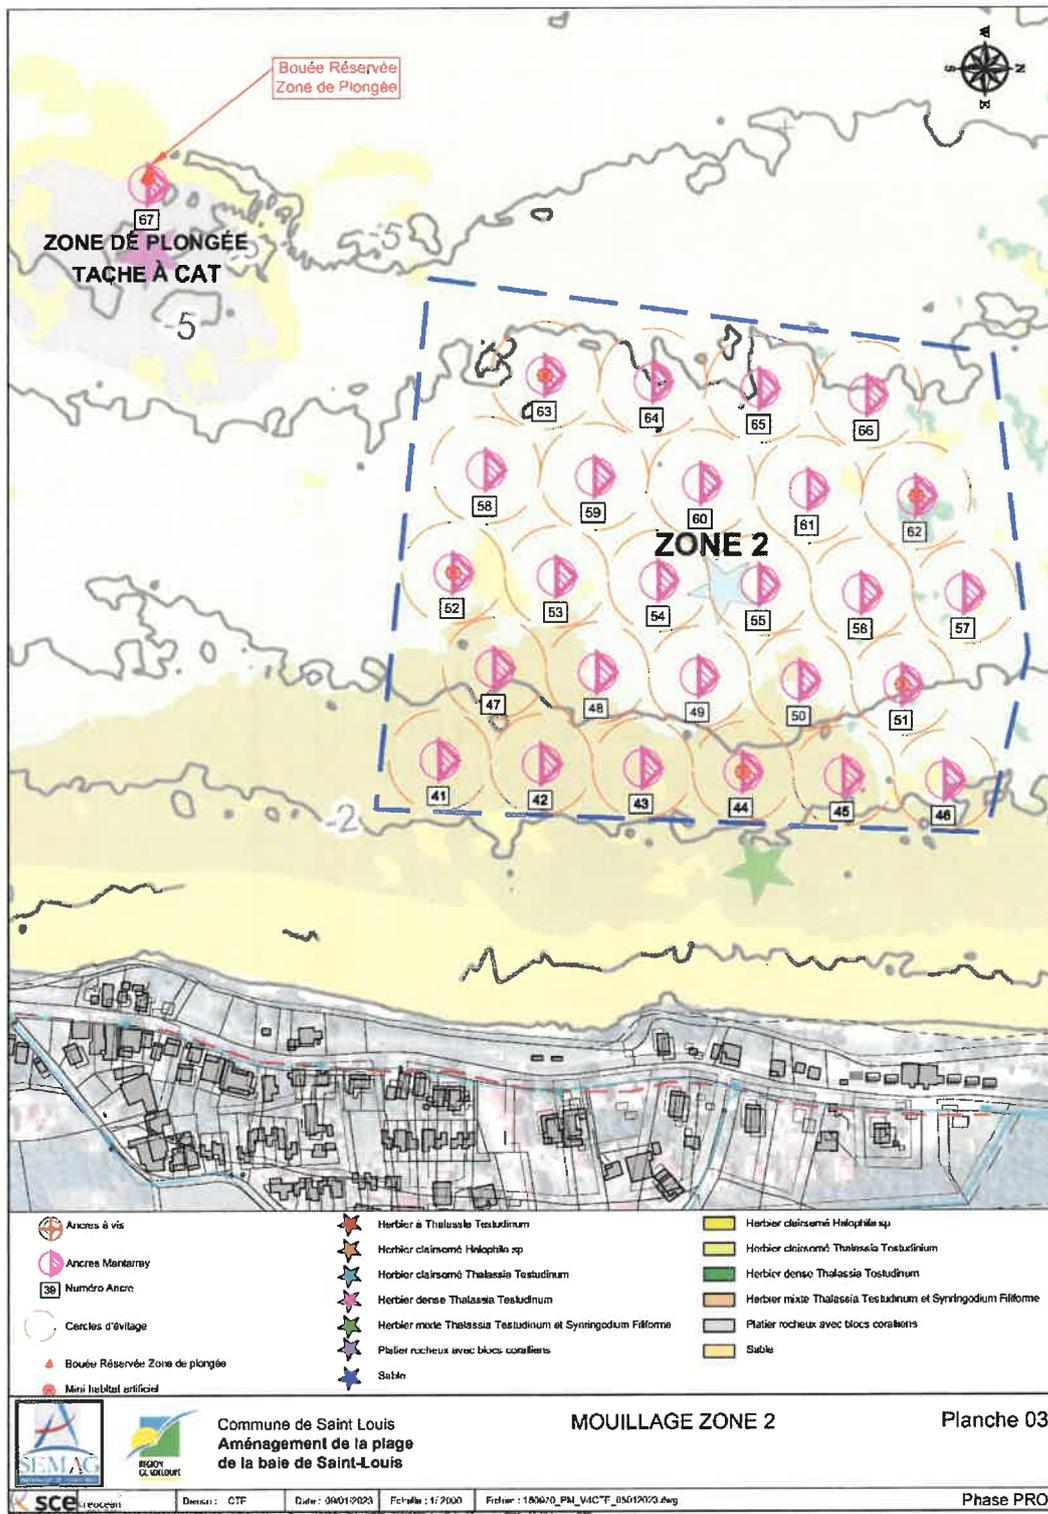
Plan de projet – Détail des mouillages de la Zone n°2
